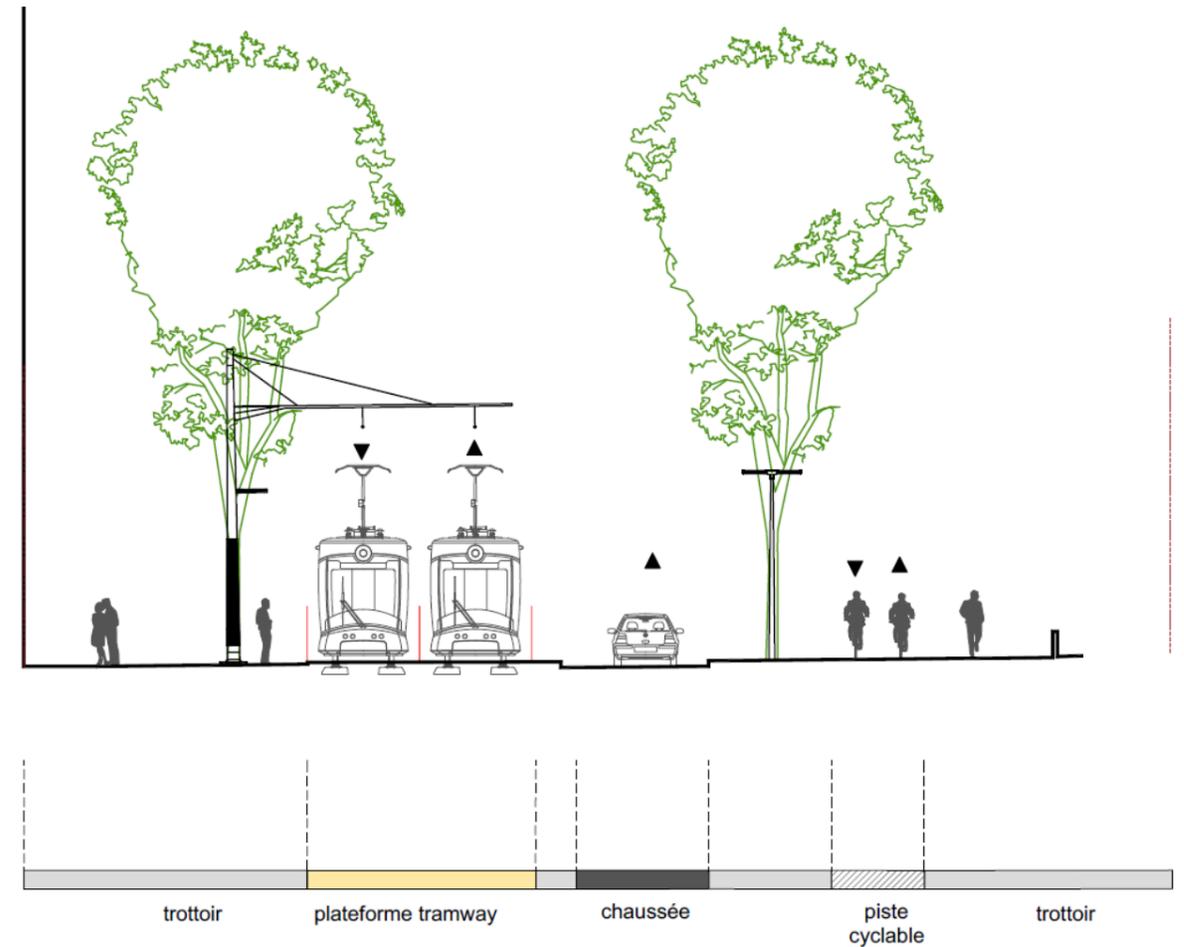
ci-contre : Profil en travers sur l'avenue Cantini jusqu'au parc du 26^{ème} centenaire
